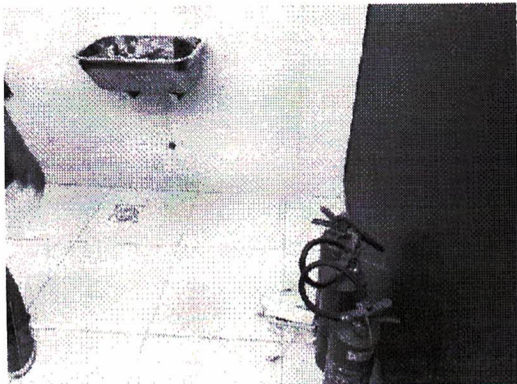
Vista parcial de uma sala onde estão guardados alguns extintores
